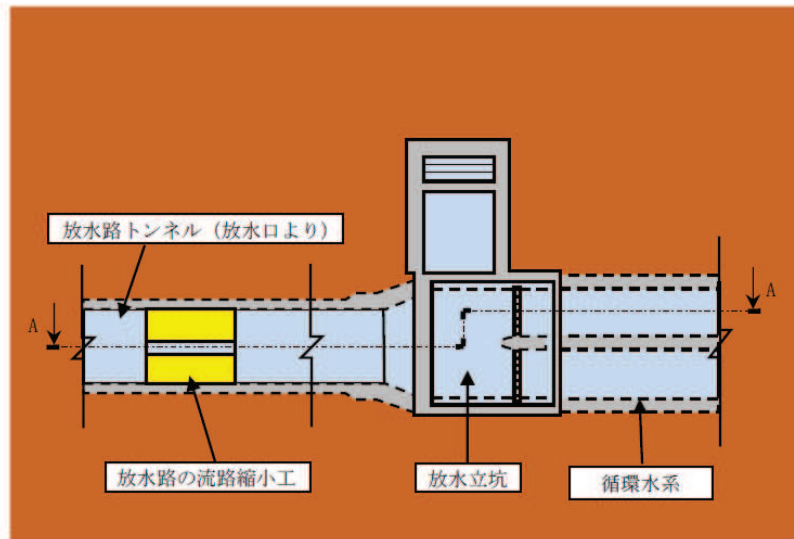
第 1 号機 放水立坑 流入対策配置図 (平面図)
